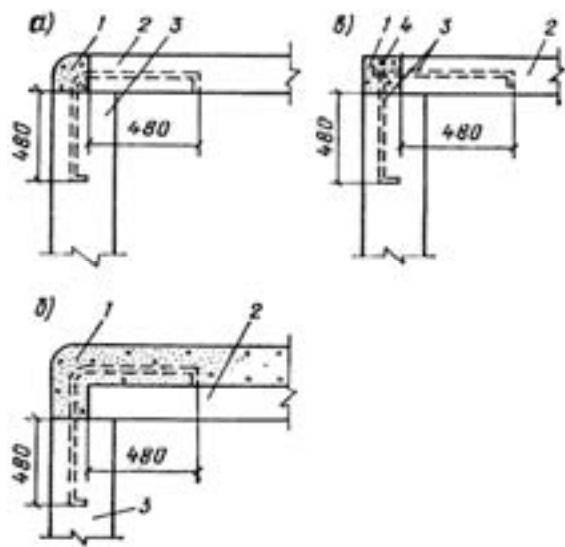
Анкерування елементів перекриття із зовнішніми стінами: а) при збірному залізобетонному перекритті; б) при збірно-монолітному залізобетонному перекритті; в) при улаштуванні стін з довгомірних конструкцій; 1 – шар монолітного бетону; 2 – елемент перекриття; 3 – анкер 0-16 мм, який заводиться у шар монолітного бетону через 1 м; 4 – стрижень 0-20 мм, що приварюється до анкерів.
